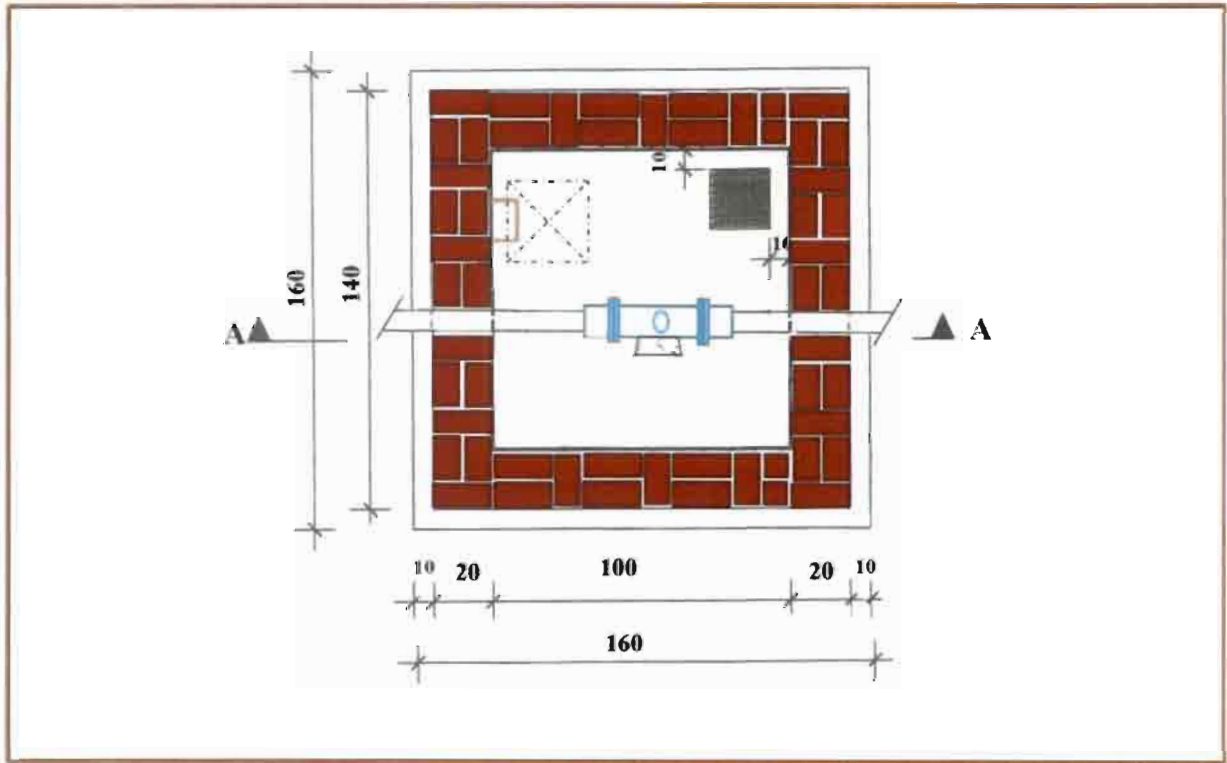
Schéma type de la chambre de vanne et sectionnement
